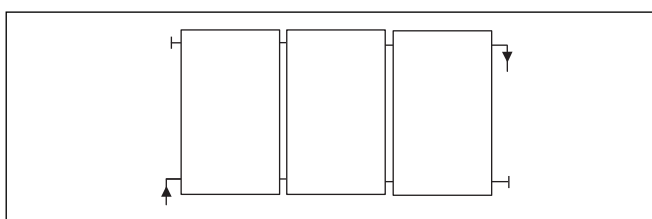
Collocazione su tetto inclinato con collettori adiacenti
